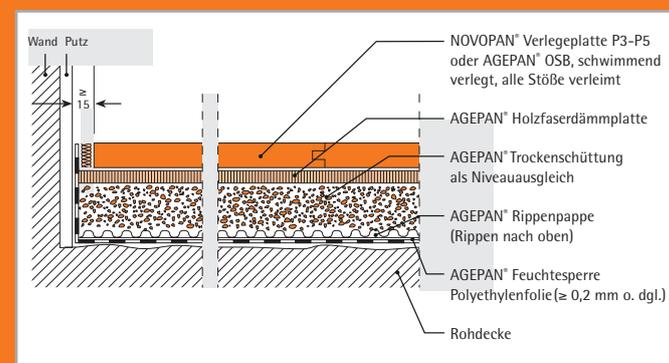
Das schwimmende Verlegen auf Stahlbetondecken mit AGEPAN® Dämmplatten und AGEPAN® Trockenschüttung (Kombinationsaufbau).
